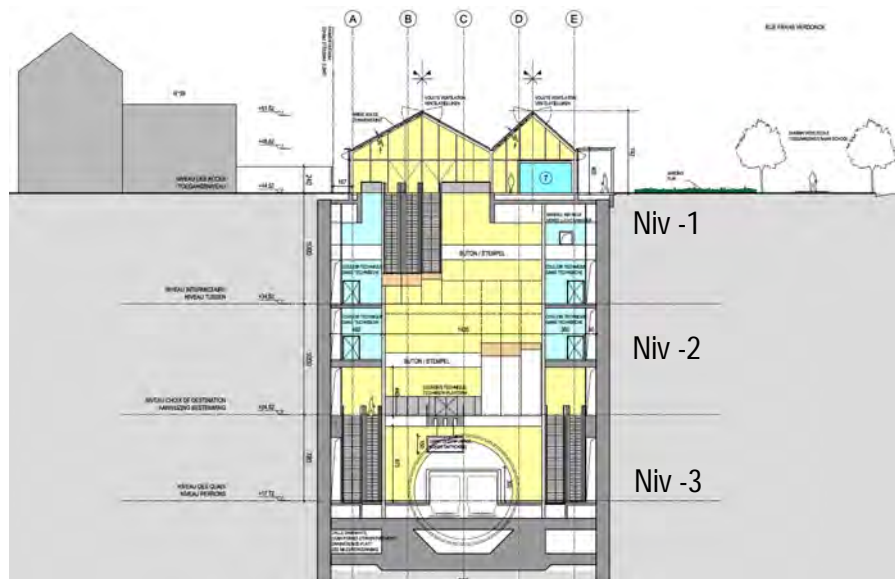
Coupe transversale de la station Tilleul (BMN, 2018)
